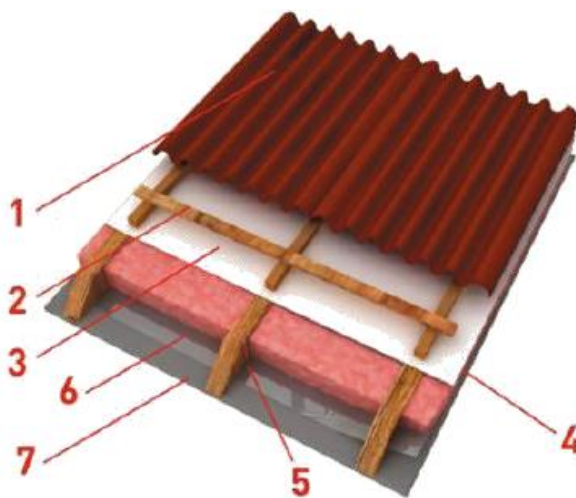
Структура скатной кровли: 1 – черепица или другой кровельный материал; 2 – шаговая (поперечная) обрешетка; 3 – ветро- и влагозащитная мембрана; 4 – слой утеплителя; 5 – стропила; 6 – слой пароизоляции; 7 – слой внутренней отделки
